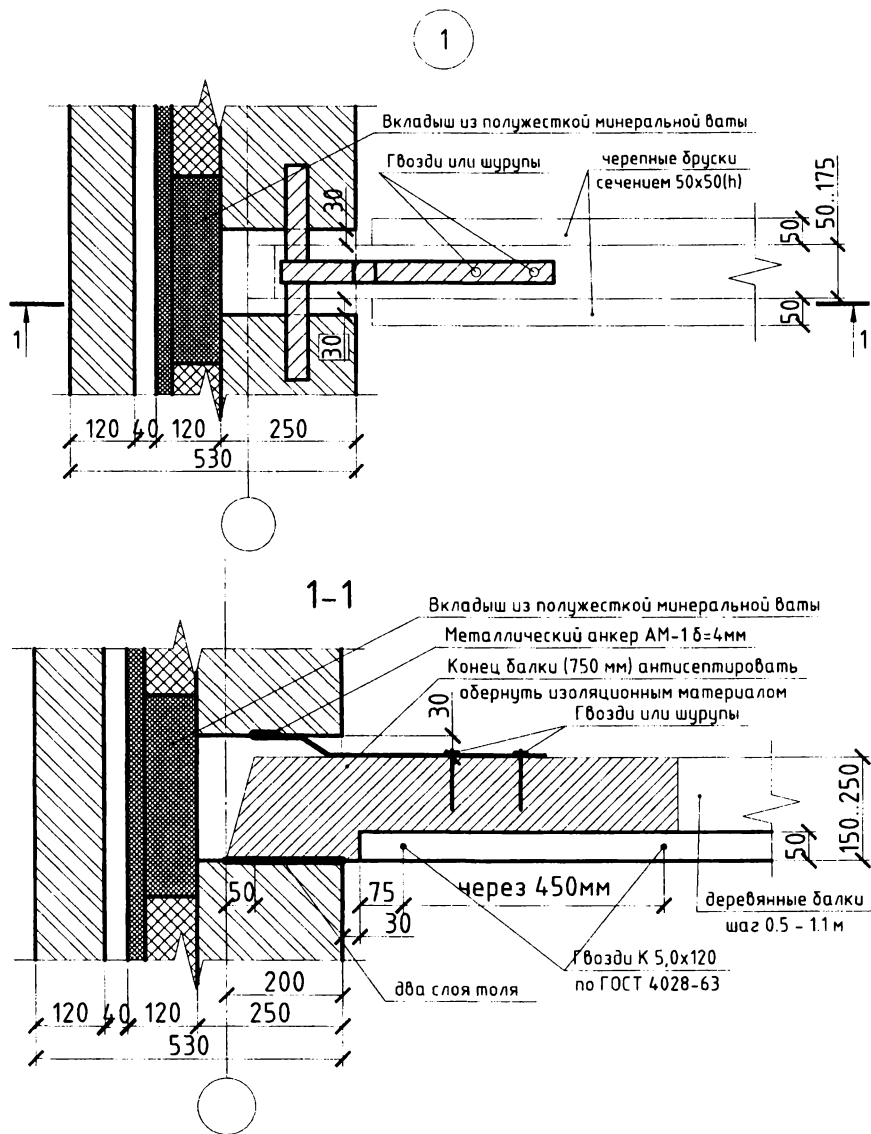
Узел опоры и анкерки деревянной балки перекрытия на наружную несущую стену (смотреть совместно с Рисунок 25 и Рисунок 30)
